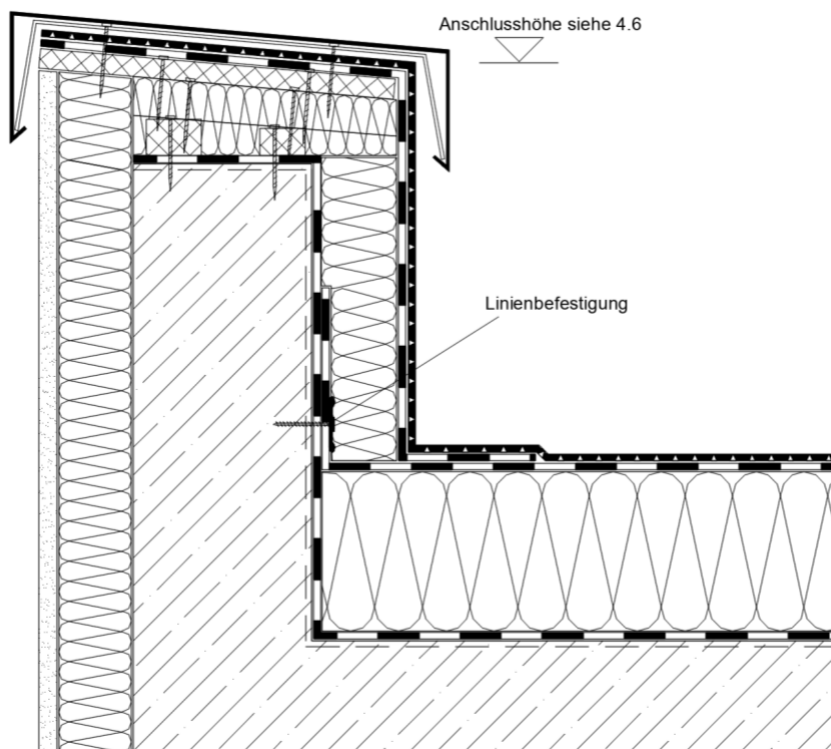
Starrer Dachrandabschluss – Ausführung mit Flüssigkunststoff
